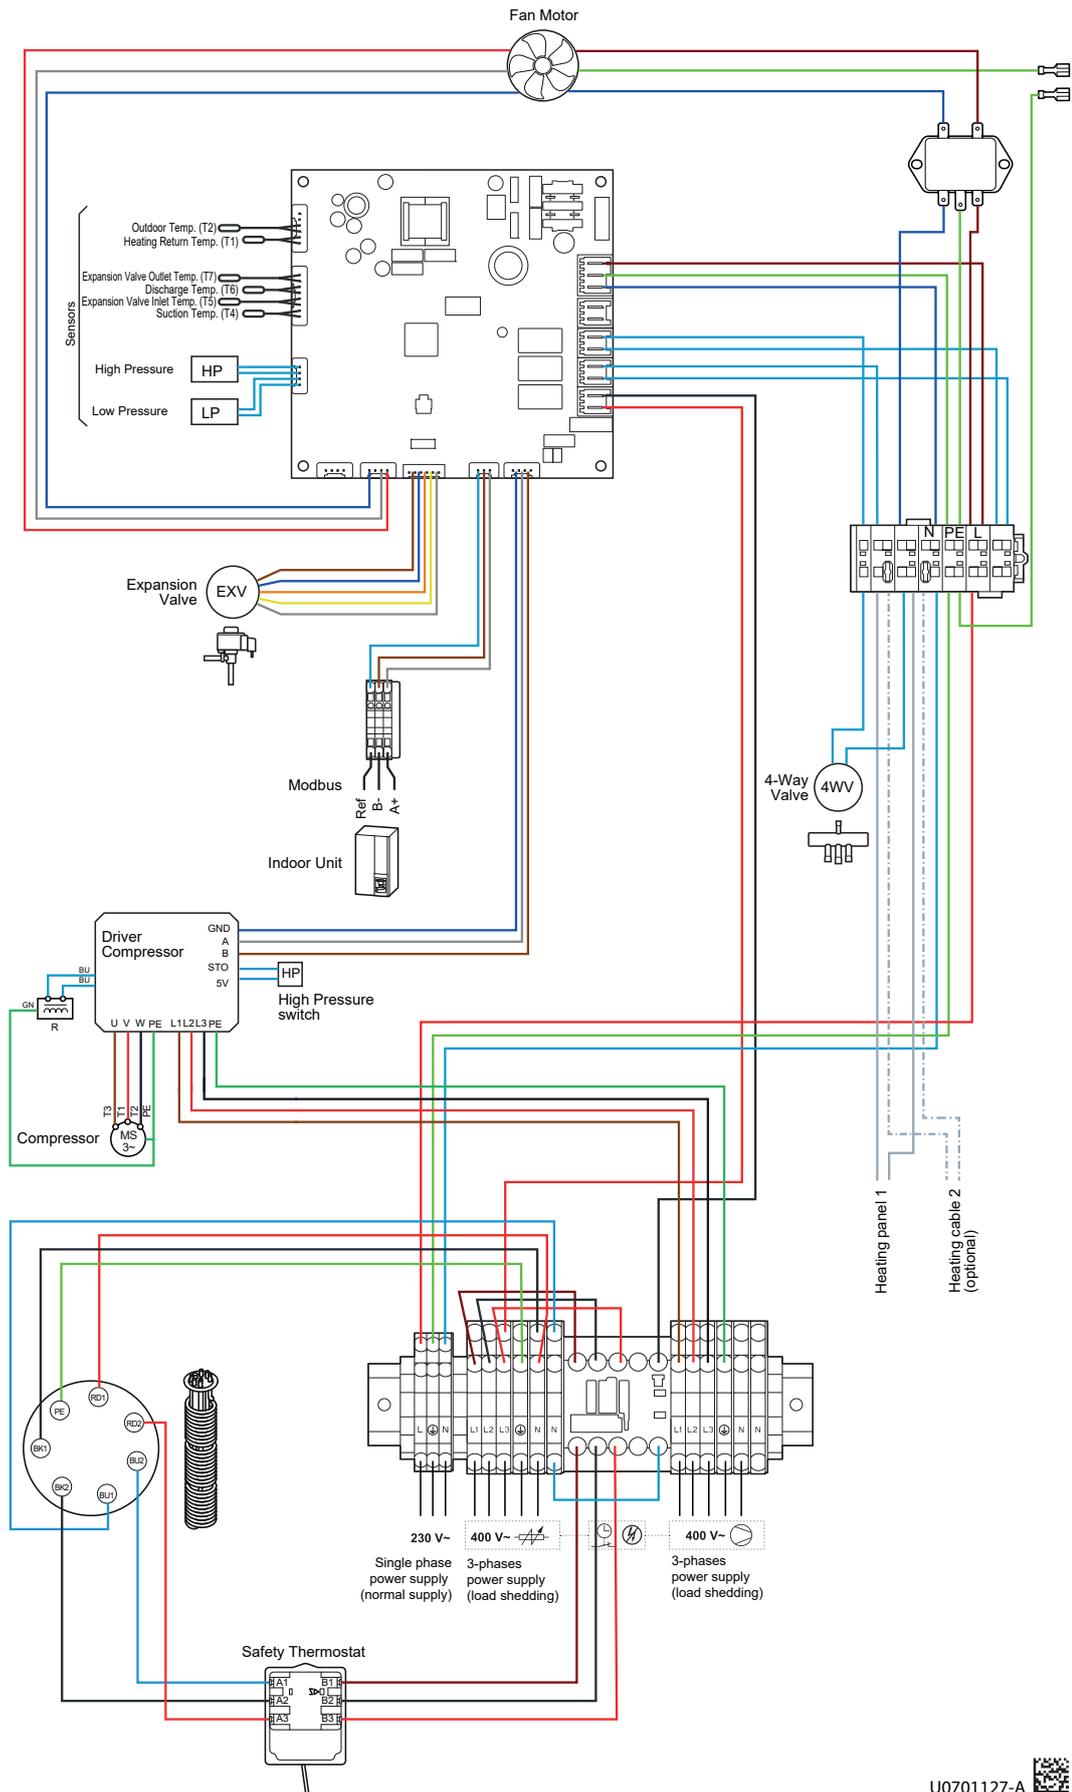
Stromlaufplan Außeneinheit Modell LWPM 14 OUTDOOR
